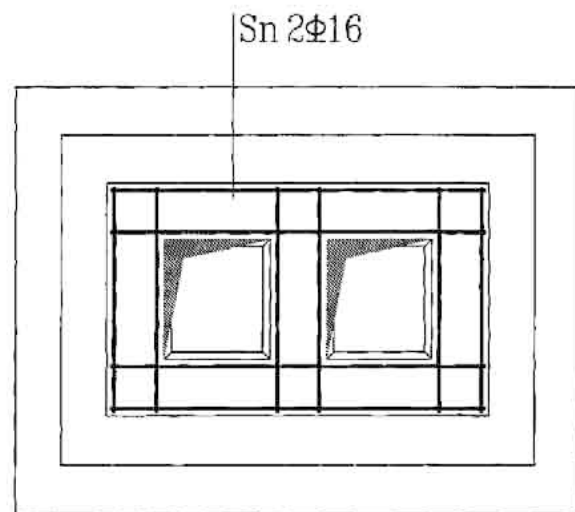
双杯口独立基础顶部焊接钢筋网示意
